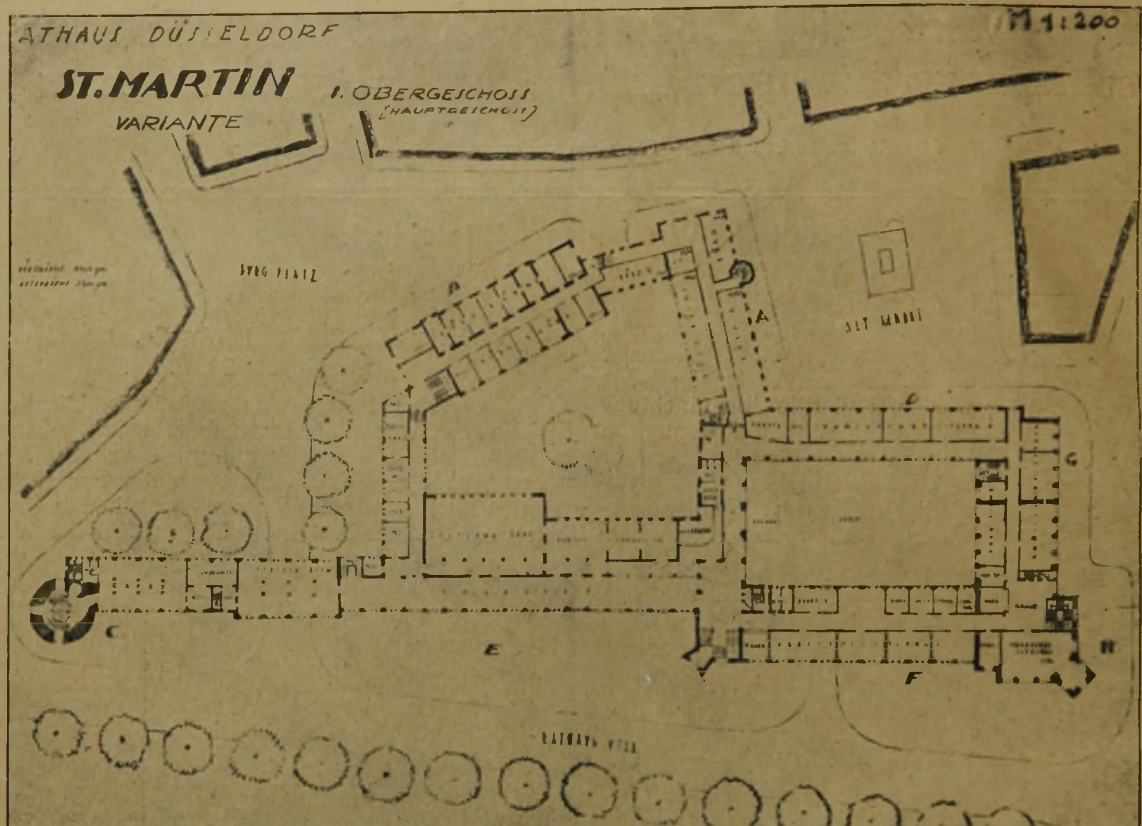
(oben). Grundriß. I. Ob. Geschoß Abb. 17 (unten). Lageplan.
